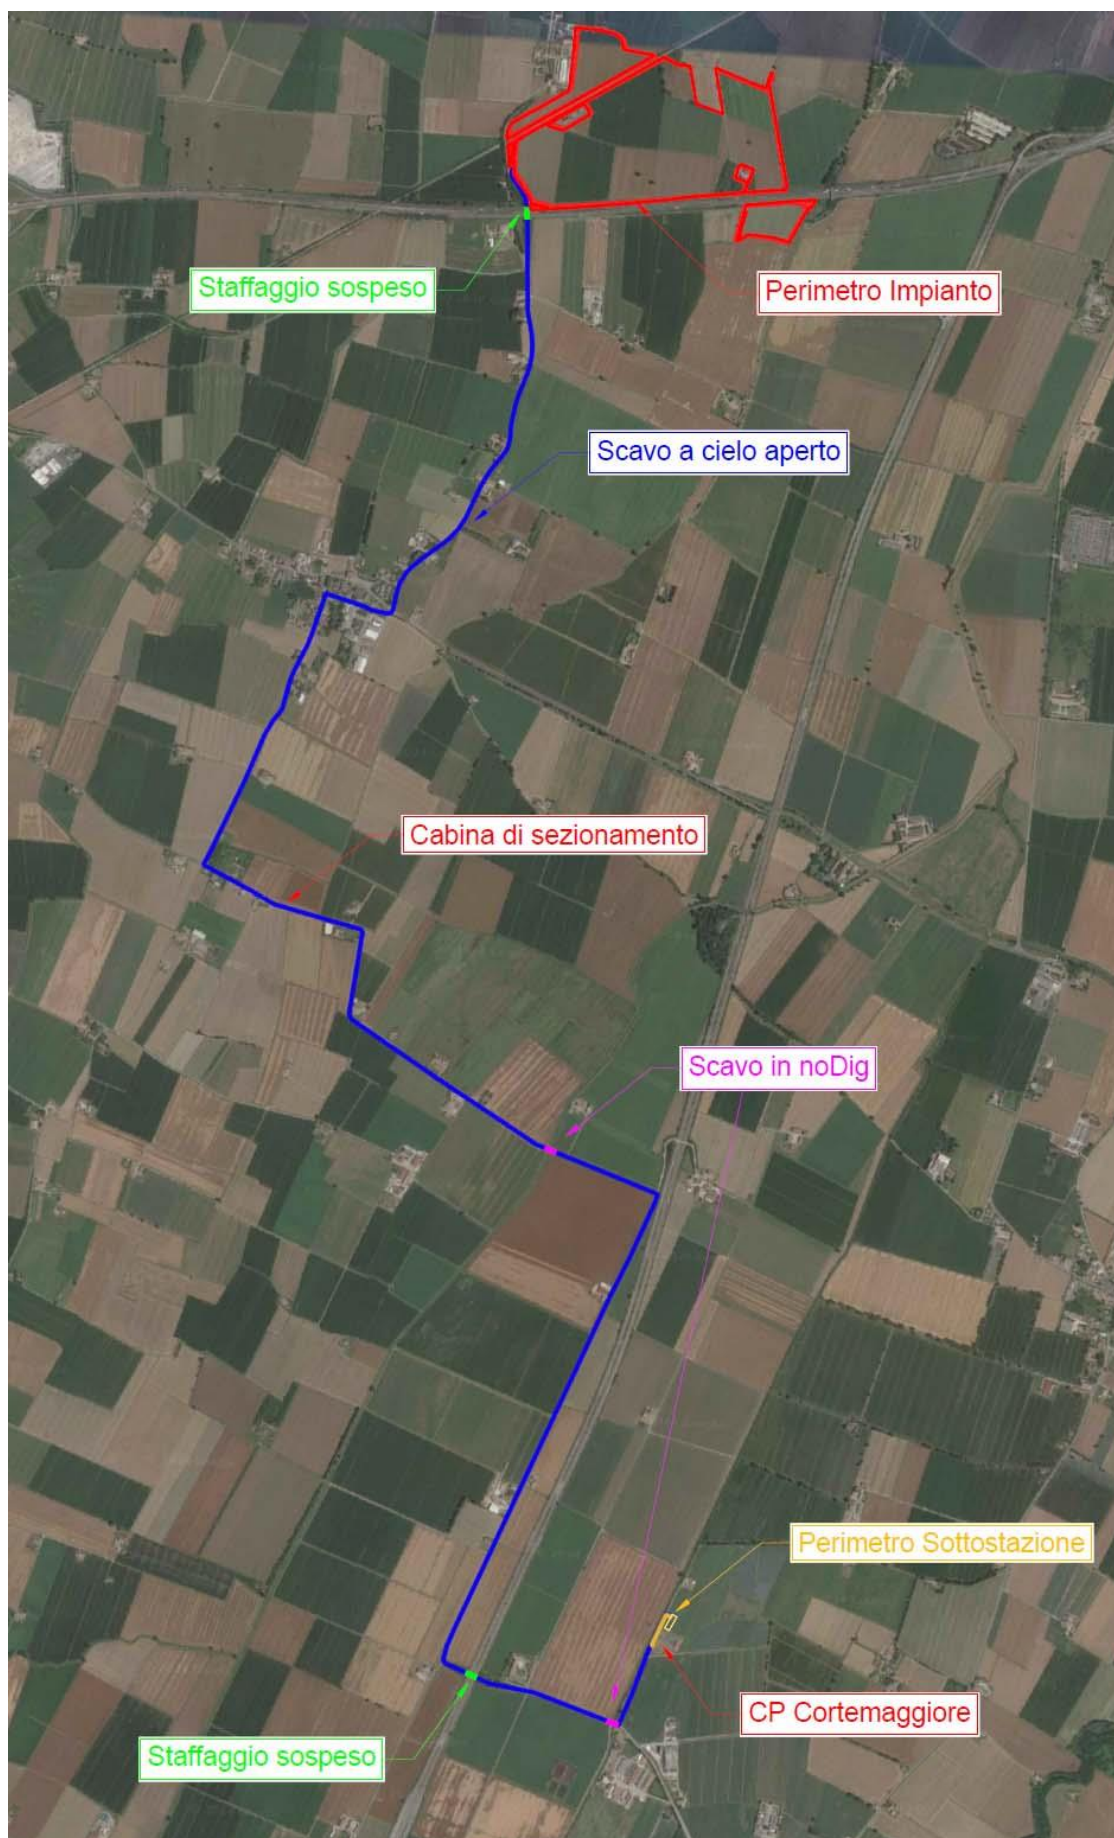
Planimetria di progetto Elettrodotto (Fonte: TAV A01)
